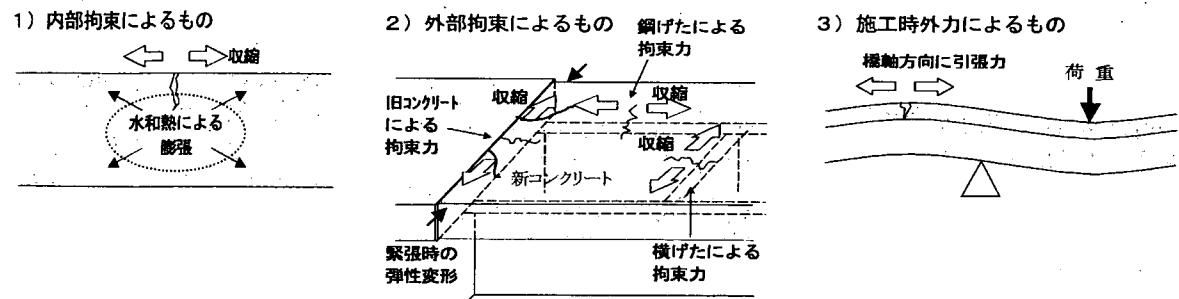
場所打ちPC床版コンクリートのひび割れ要因
